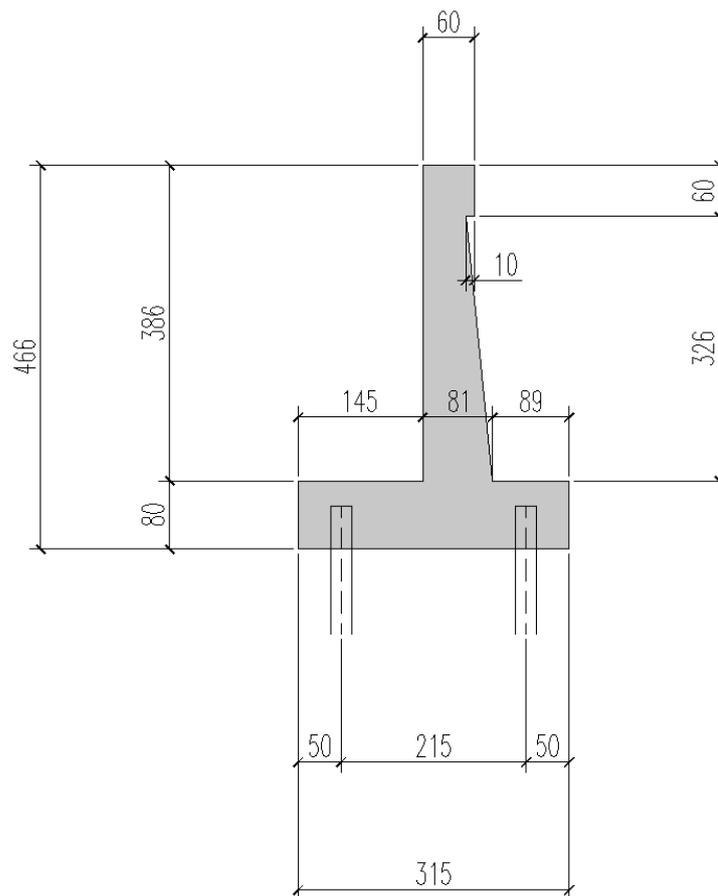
Carpenteria della Sezione ad altezza maggiore del Muro M01
